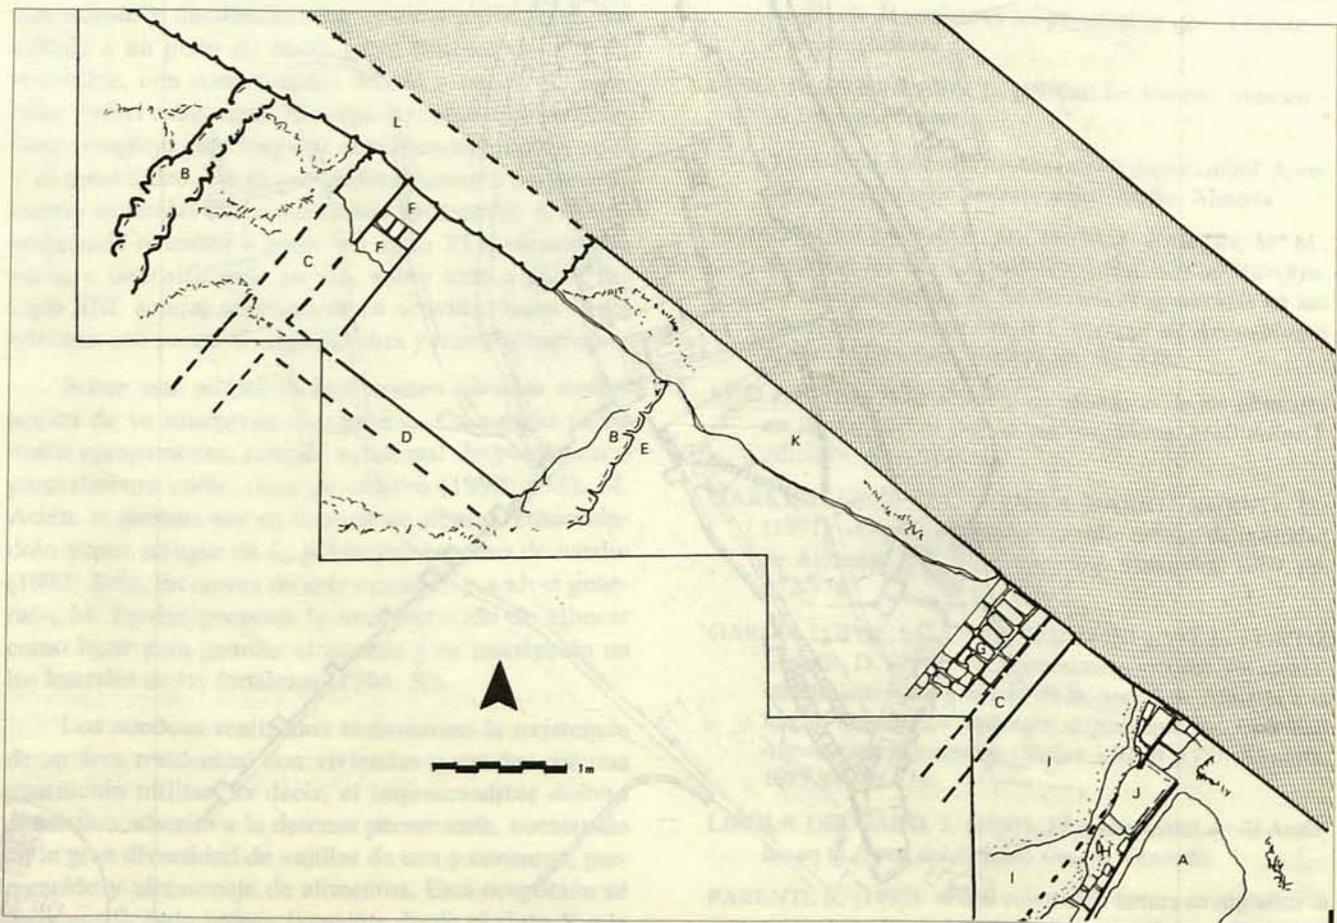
Planta de viviendas superpuestas en el extremo inferior de la muralla Norte
